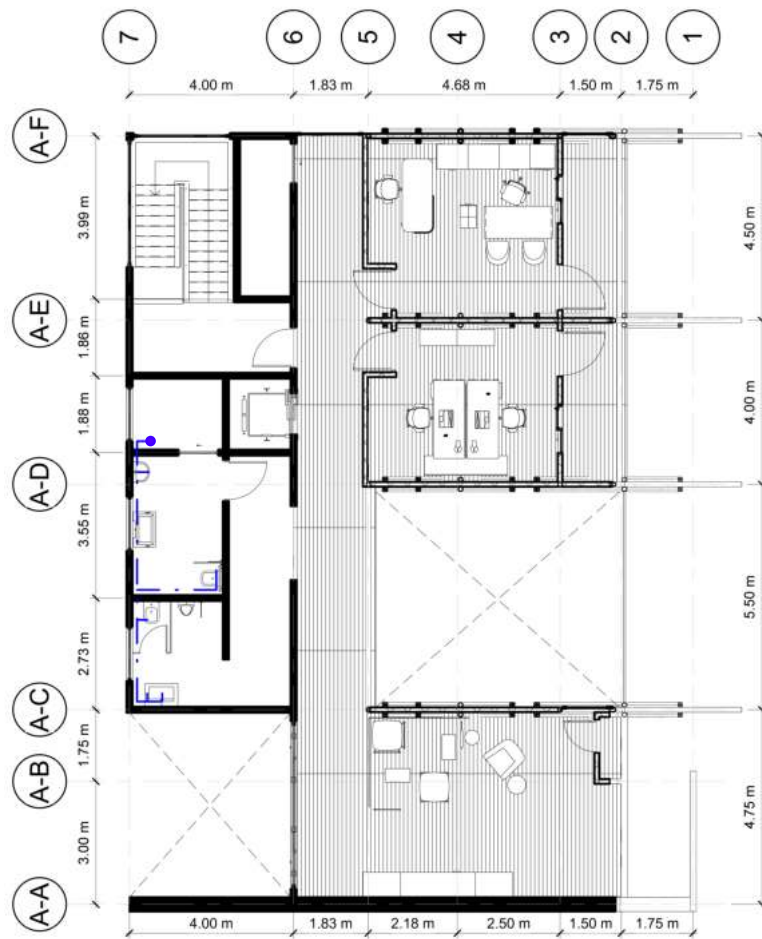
PLANTA MECÁNICA NIVEL +4.00 SIN ESCALA
